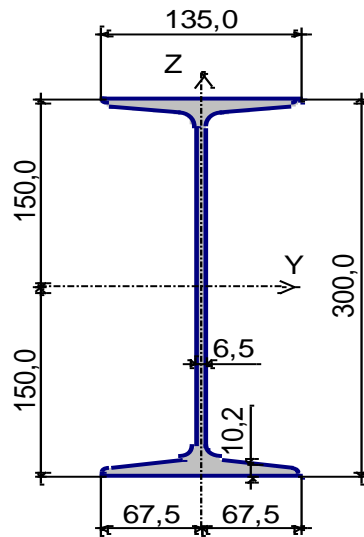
Переріз двутавр з ухилом полок по ГОСТ 8239-89 №30
